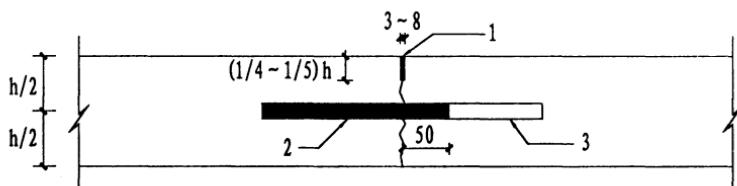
设传力杆假缝型横向缩缝构造(尺寸单位:mm)
